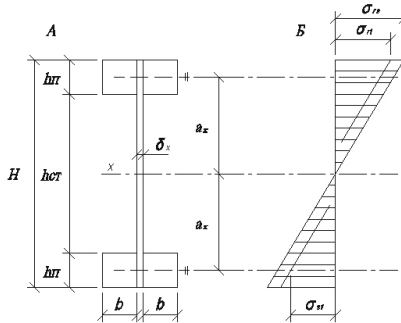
Данные к расчету. А- поперечное сечение составной двутавровой балки; Б- эпюра нормальных напряжений в поперечном сечении составной двутавровой балки.
